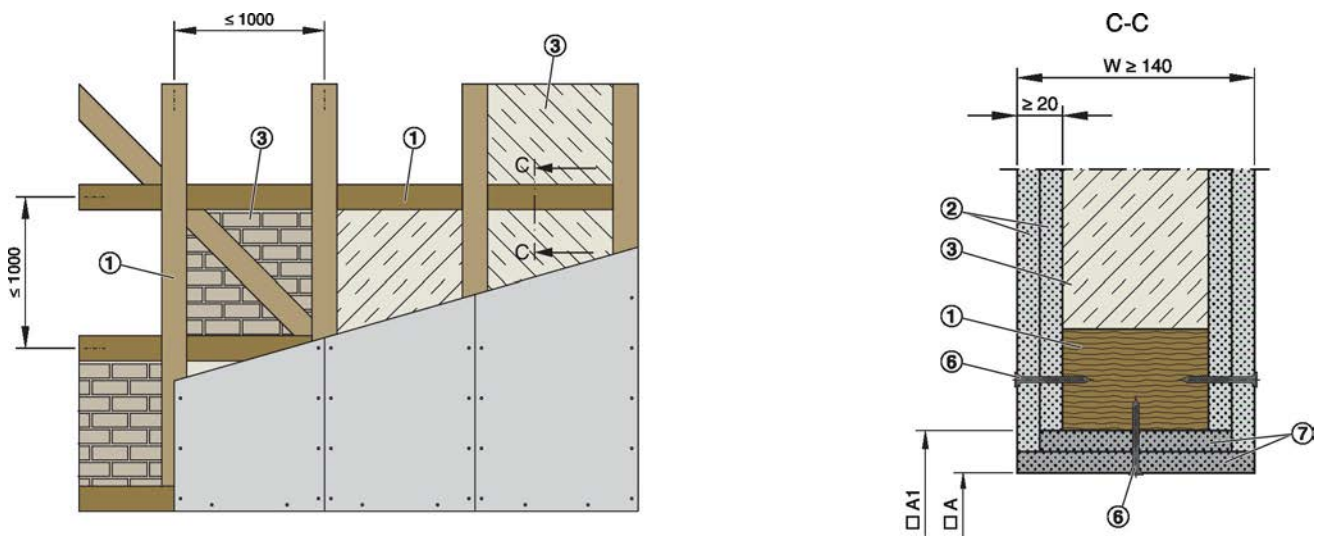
Pared ligera de sectorización con entramado parcial de madera y aislamiento a ambos lados
